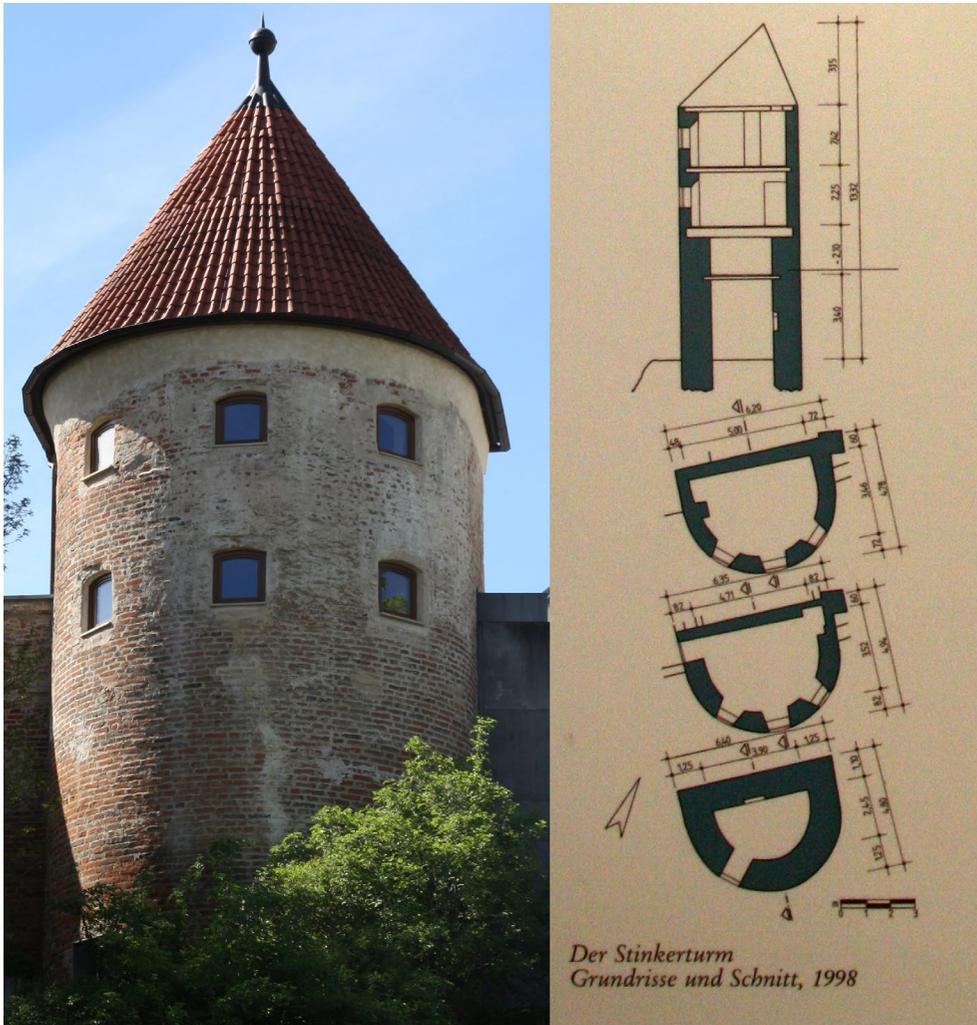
Stinkerturm, Museum Dingolfing, Montage, Foto: 2017, JL, Grundriss und Schnitt, 1998
